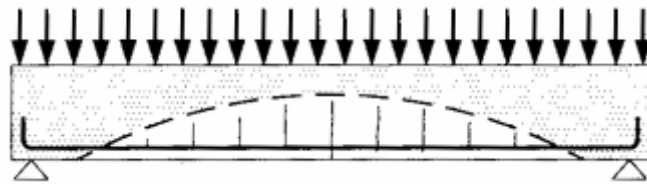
Efecto Arco en viga cargada uniformemente (Proyecto y Cálculo de Estructuras de Hormigón / Calavera)
